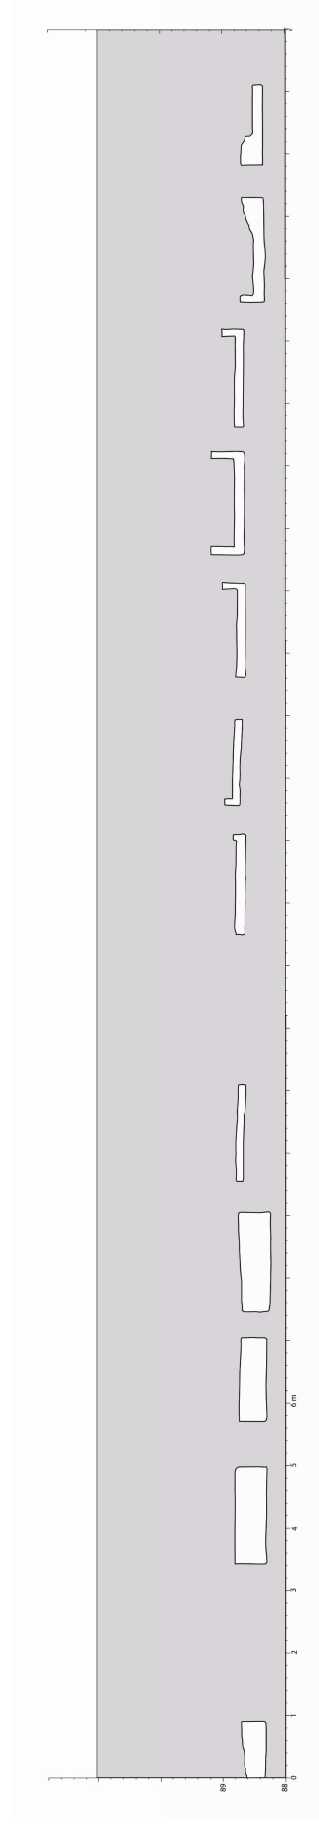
Ala sul do criptopórtico: Levantamento das pias encastradas no alçado sul.
